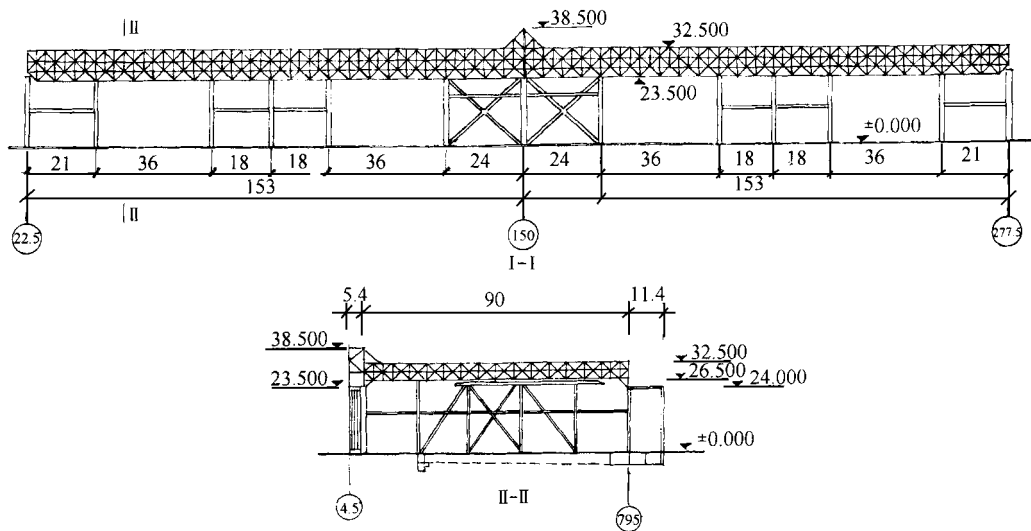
屋盖钢结构剖面图 (单位: m)
